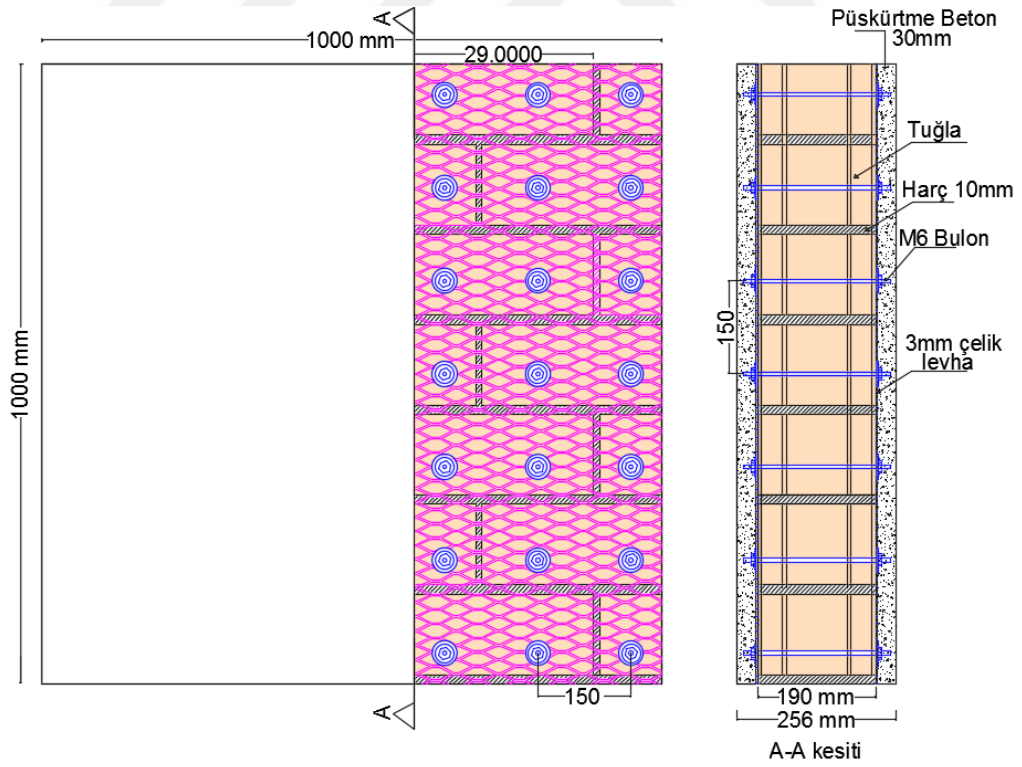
MBW 2,0-200 Deneme elemanı
